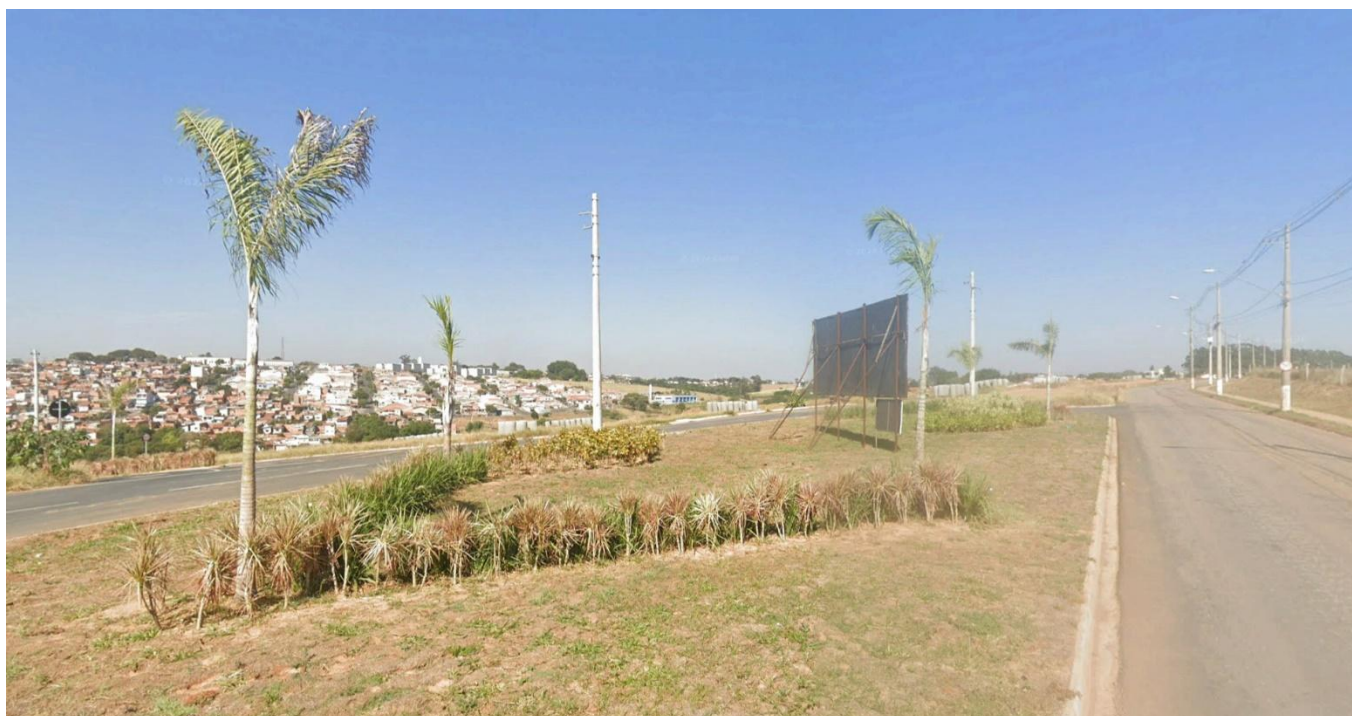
Infraestrutura – Estrada Municipal Vicente Teles de Miranda BTV
